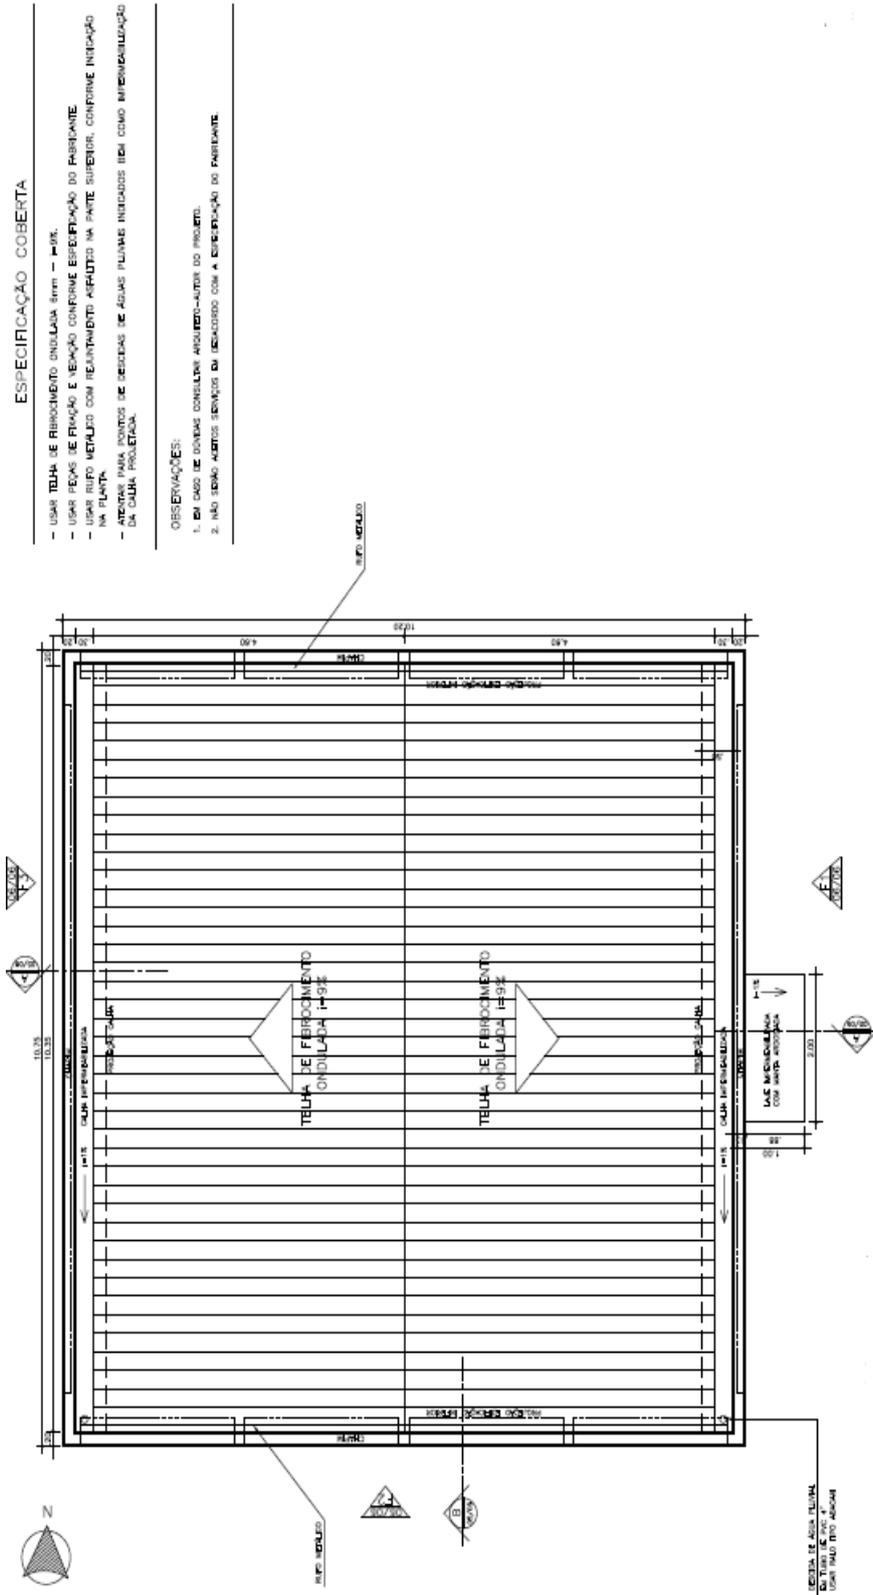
Planta de cobertura do projeto original do estudo de caso. (Fonte: COP/UFC)
